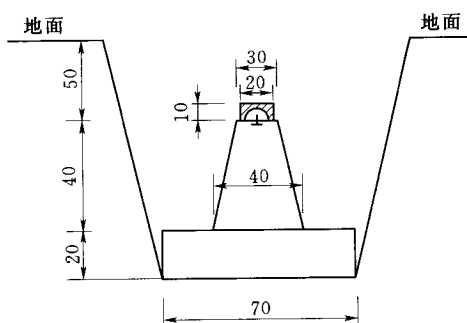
2 混凝土普通水准标石埋设图 (单位: cm)
